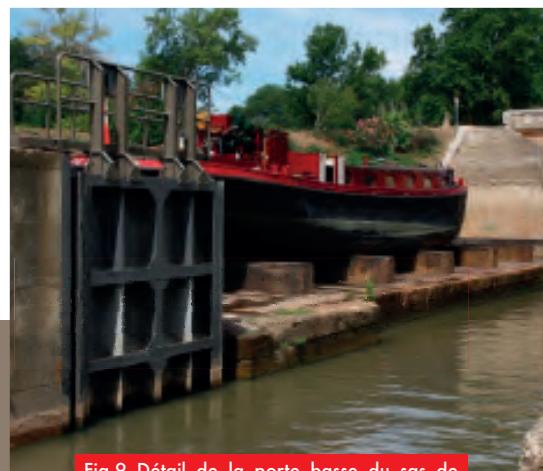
Détail de la porte basse du sas de l'épanchoir.
